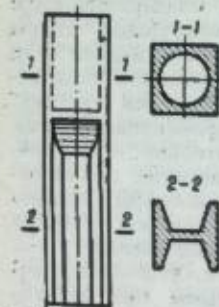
Железобетонный свайный фундамент стаканного типа для консольных опор.
